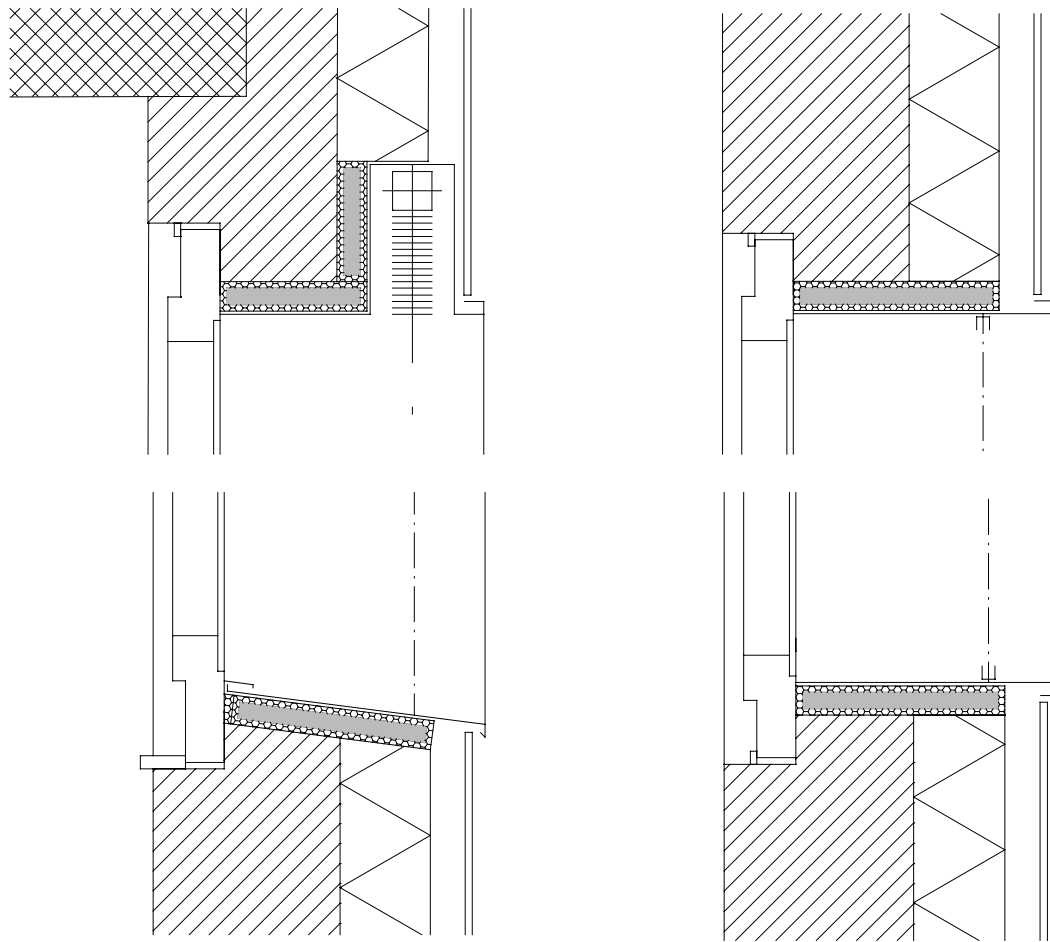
Schnitt und Grundriss einer möglichen Fassadensanierung. Mit dem Einsetzen von VIP im Leibungs-, Sturz- und Brüstungsbereich wird die Tageslichtsituation der Innenräume trotz optimaler wärmetechnischer Anschlusslösung nur unmerklich vermindert.
